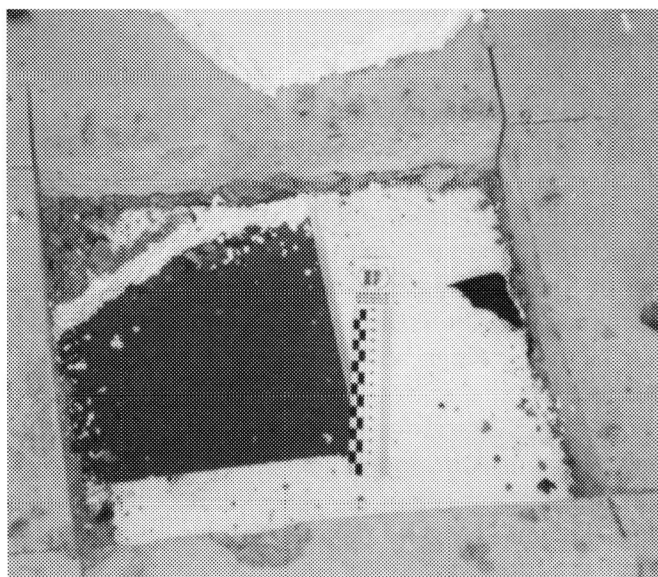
Eine Folie auf einer Betondecke verlegt, führt zu neuen Problemen.
